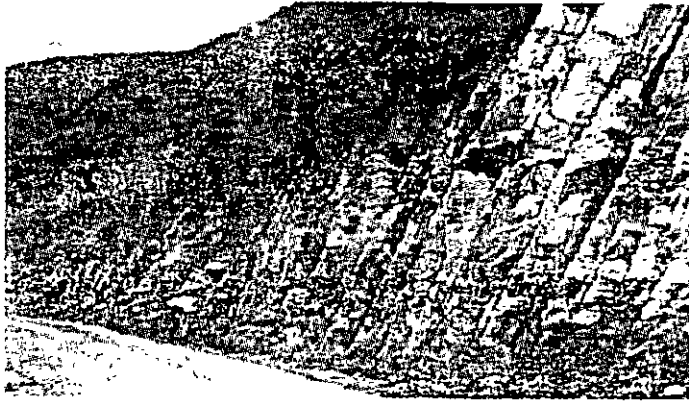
Planos de estratificación con buzamiento hacia la excavación.
